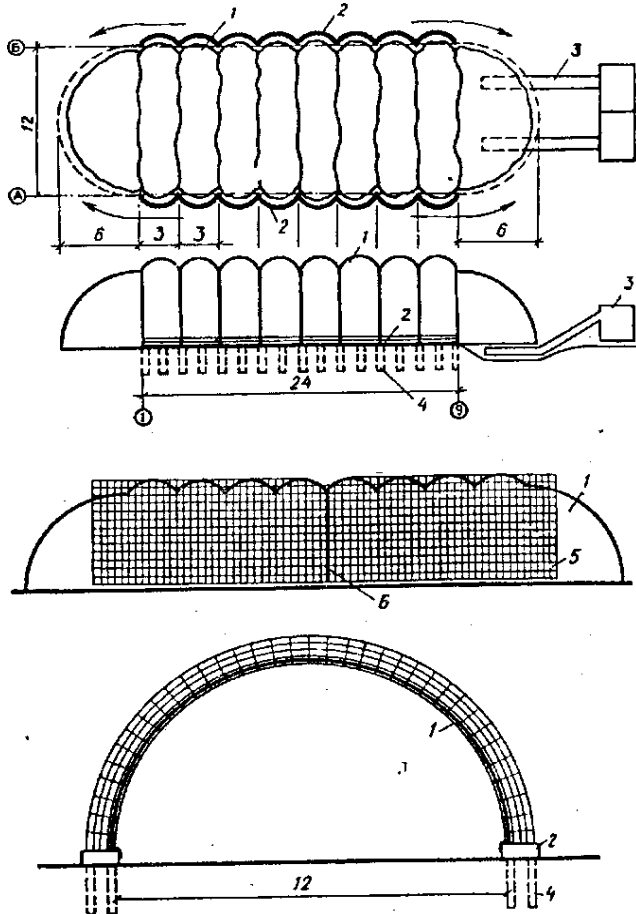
Технологія улаштування пневмоопалубки (а) і монтажу арматурного заповнення (б) армоцементного хвильового склепіння:
